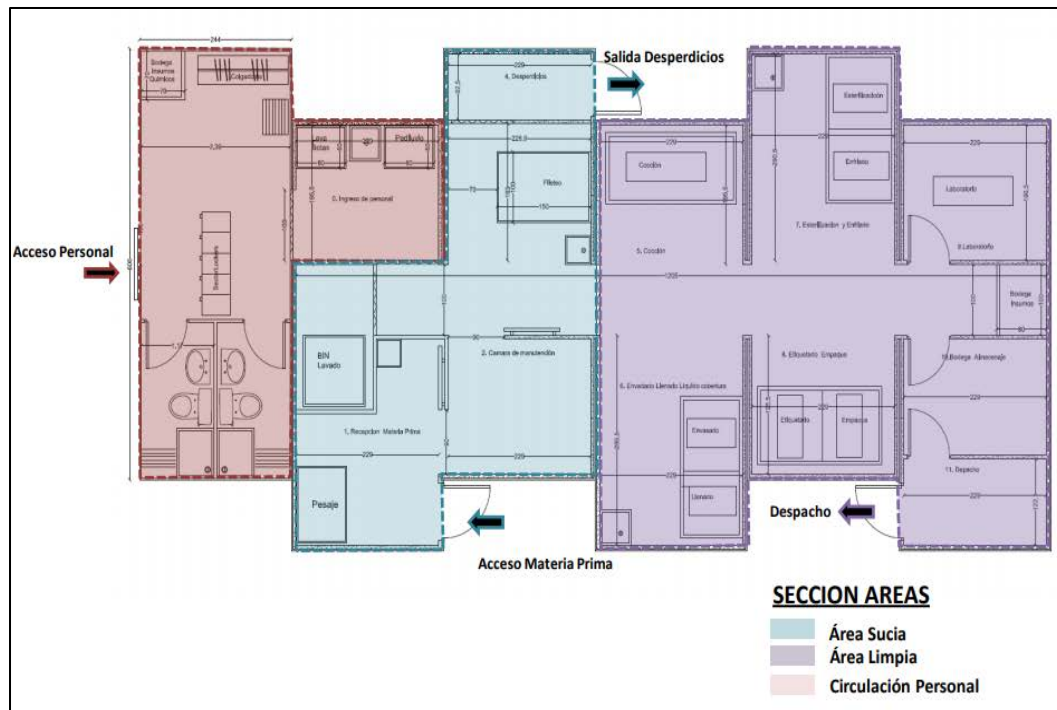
Plano de secciones de áreas sucias y limpias en el diseño de planta de proceso conserva
